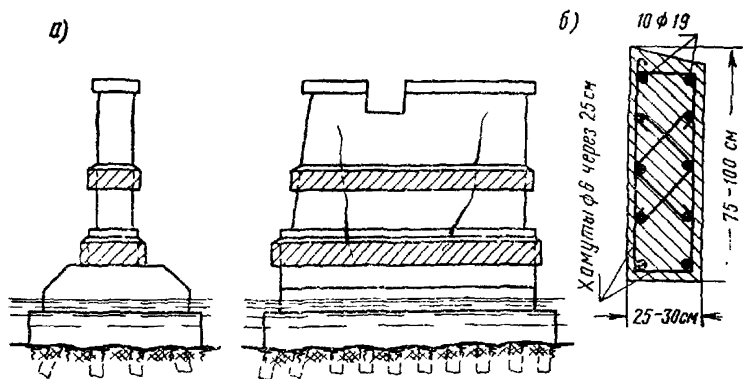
Усиление опоры железобетонными поясами: а — общий вид усиления опоры; б — деталь устройства железобетонного пояса
